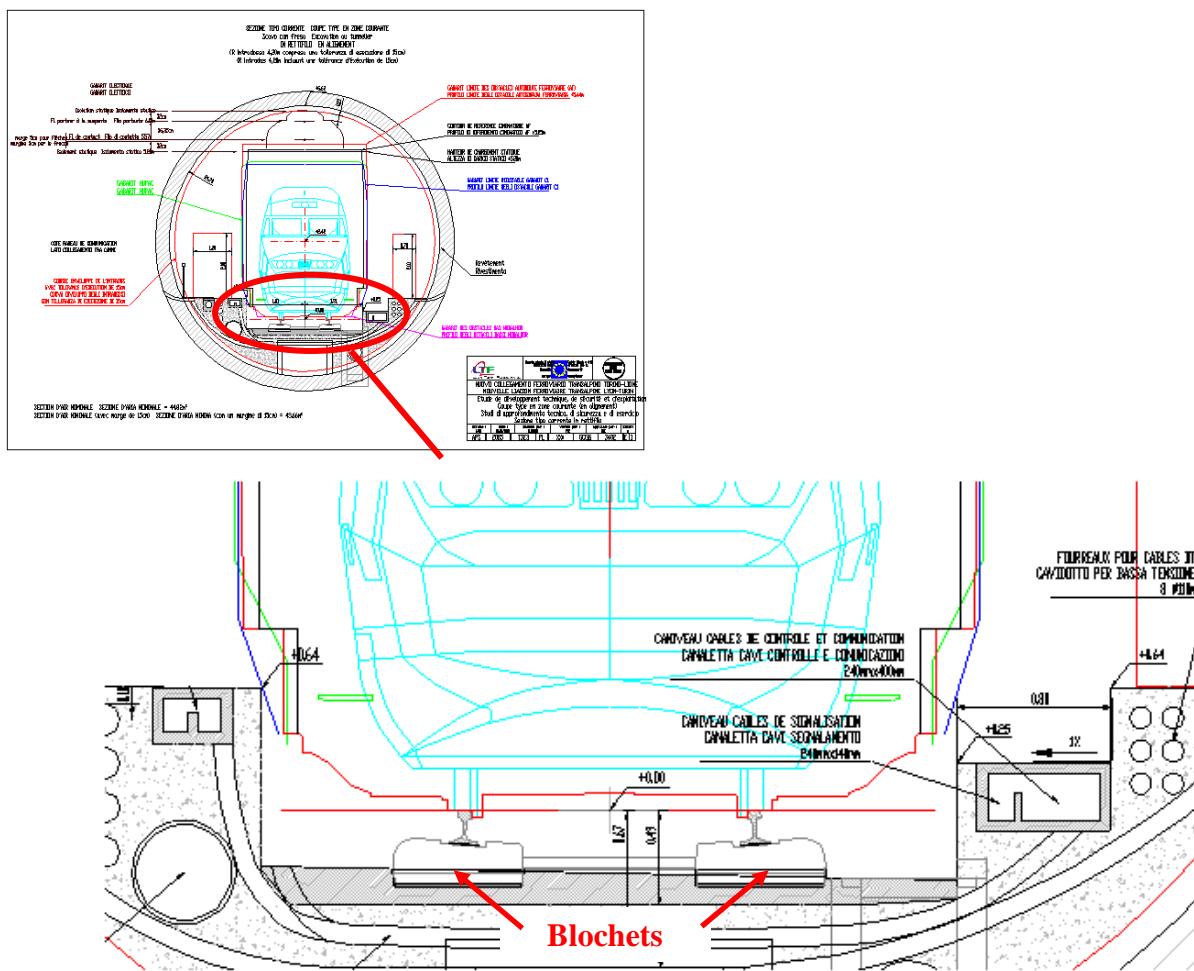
Coupe type en tunnel. Zoom au niveau bas
